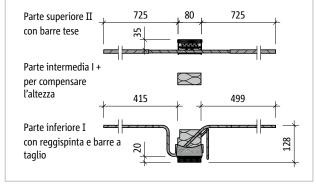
Schöck Isokorb® T tipo KL-F M1 – M7-V1/V2
